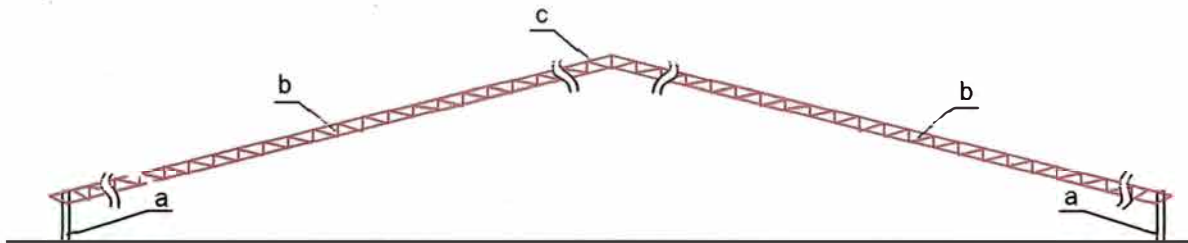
Estructura de cercha. a- Columna. b- Viga. c- Cumbrera
